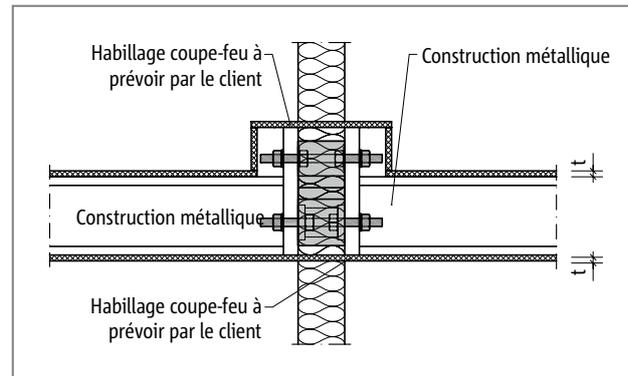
Protection incendie Schöck Isokorb® T type S : Bardage de protection incendie sur site pour plaques frontales saillantes ; coupe
